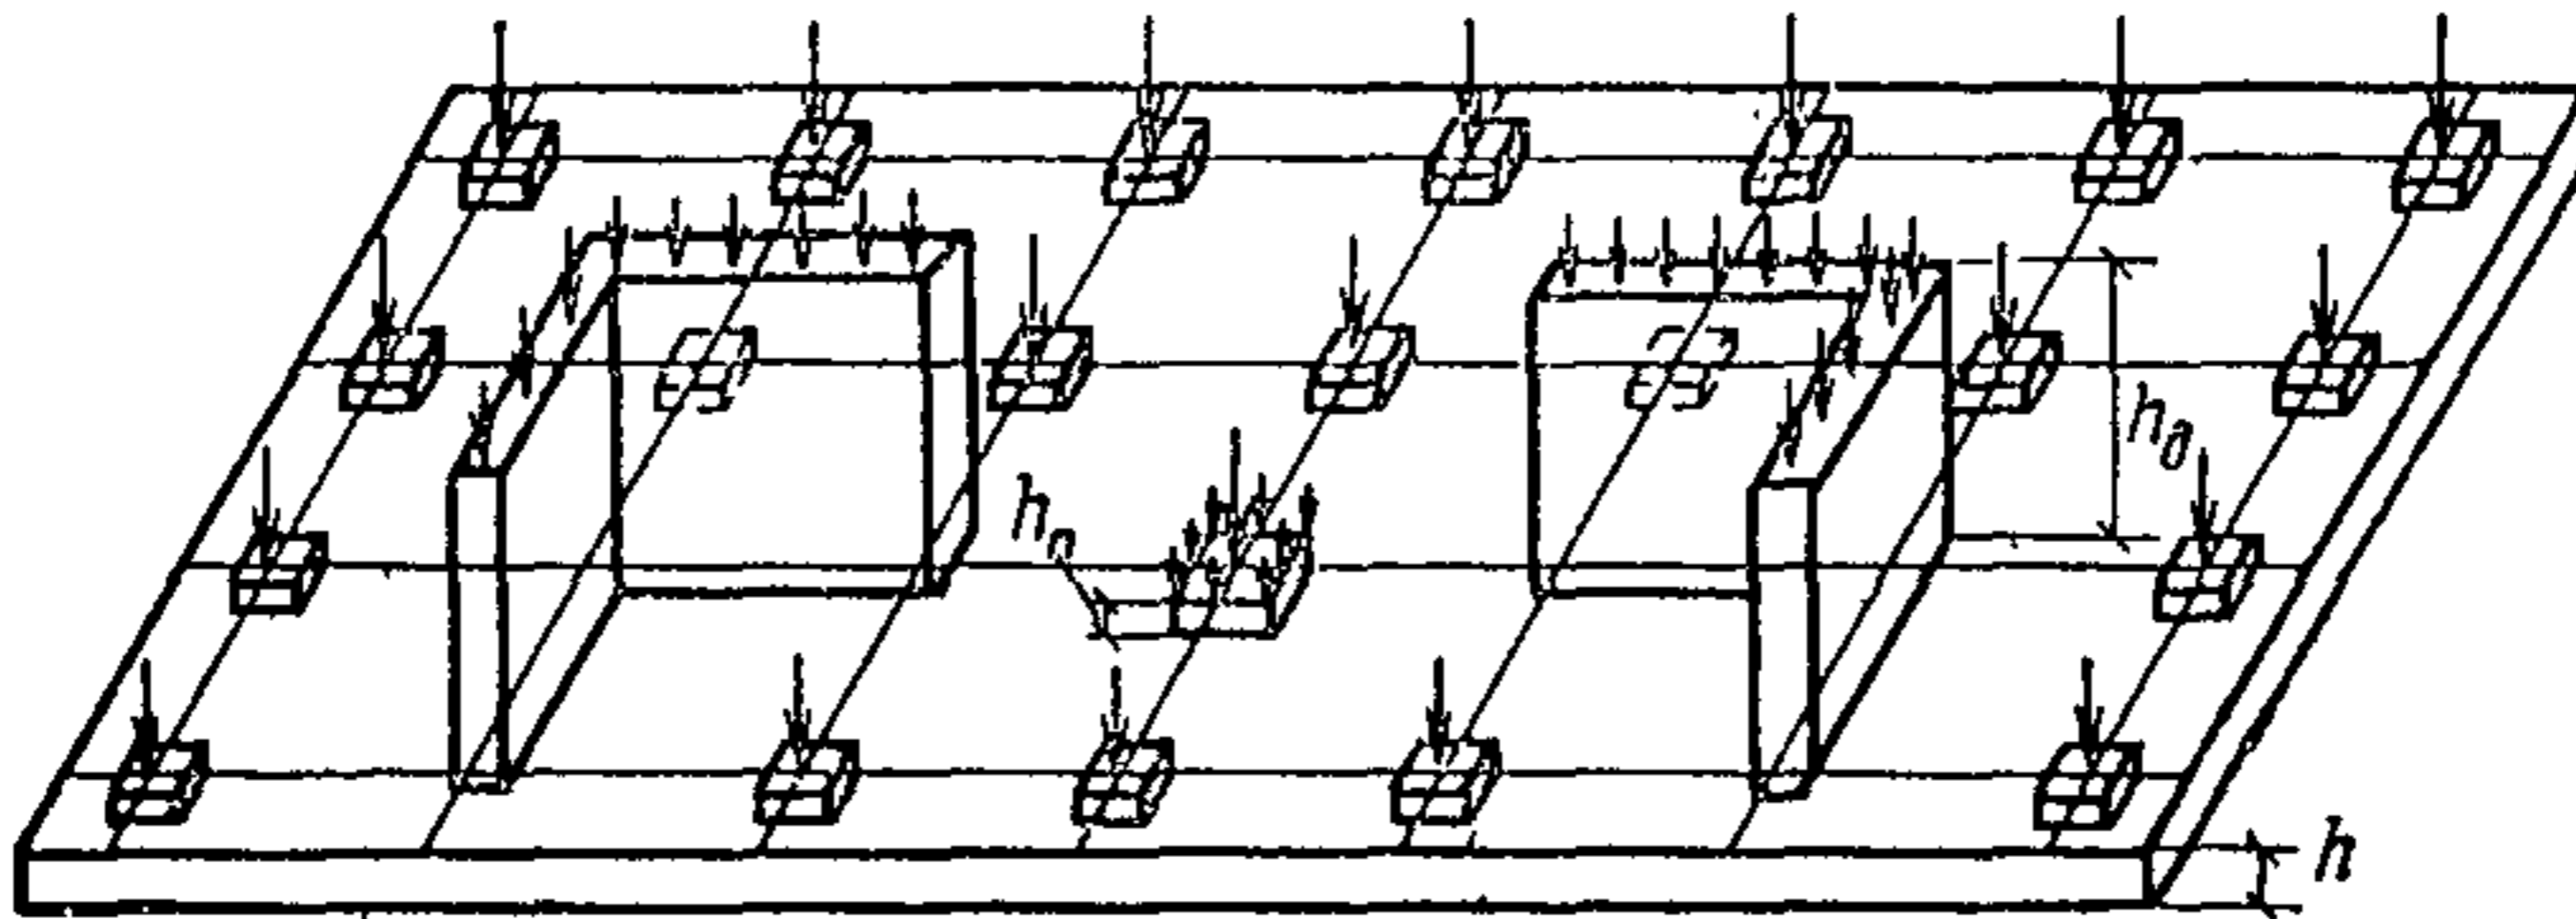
Расчетная схема плиты ступенчато-переменной толщины, нагруженной вертикальными нагрузками, равномерно распределенными по отдельным прямоугольным площадкам
